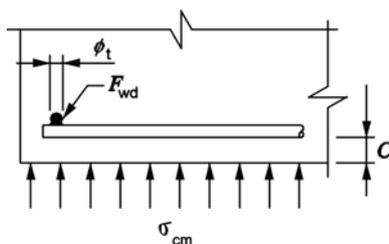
焊接橫向鋼筋作為錨固措施
